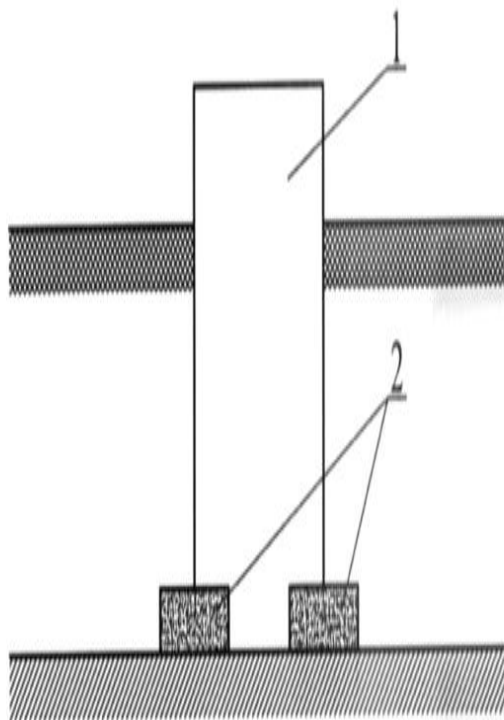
Усиление ленточного фундамента уширением подошвы:
